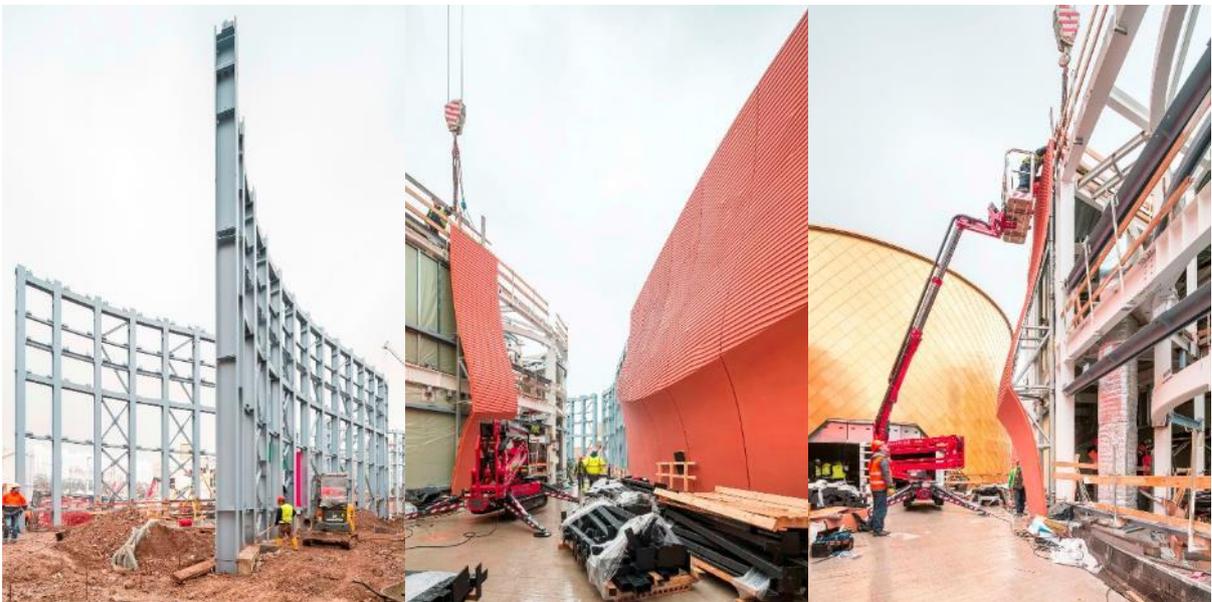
Fotografias da construção do Pavilhão EAU | EXPO Milão 2015
